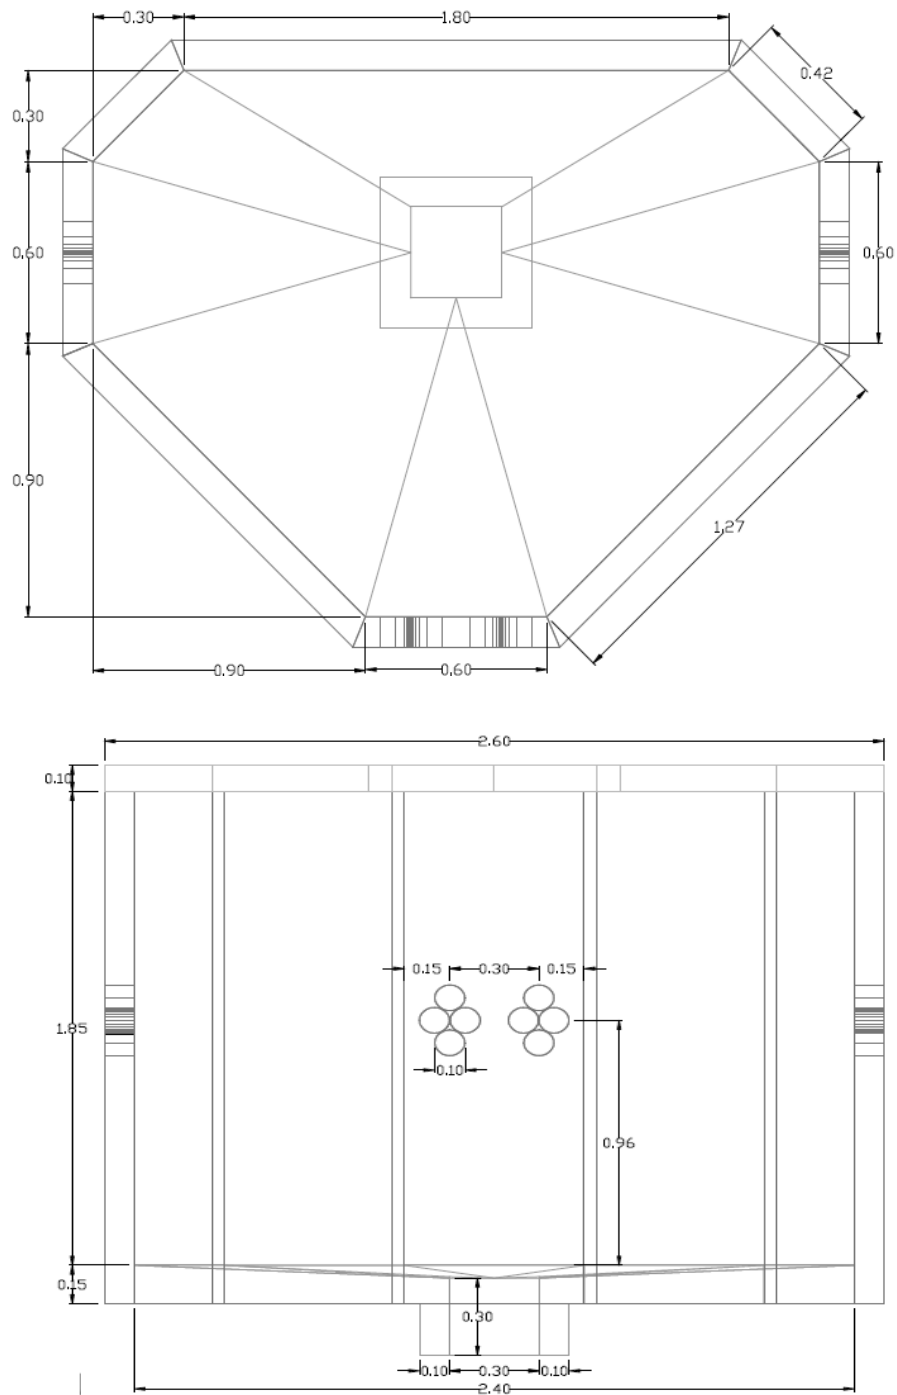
Planos de construcción del pozo de visita de media tensión, tipo T.
